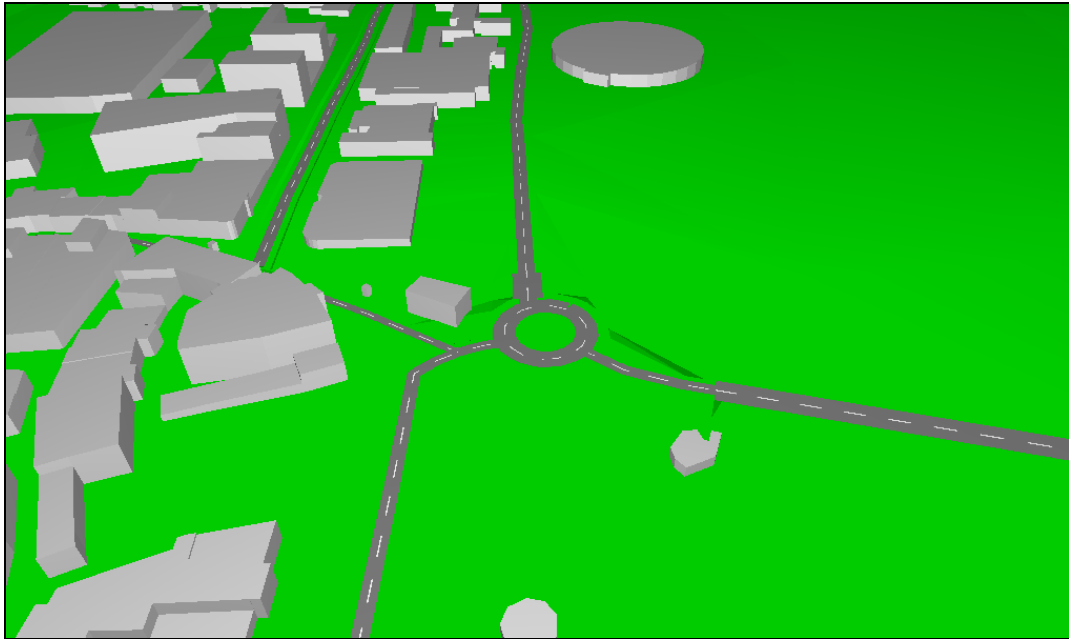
Vista tridimensional das novas via e rotunda modeladas na vila de Coruche.
